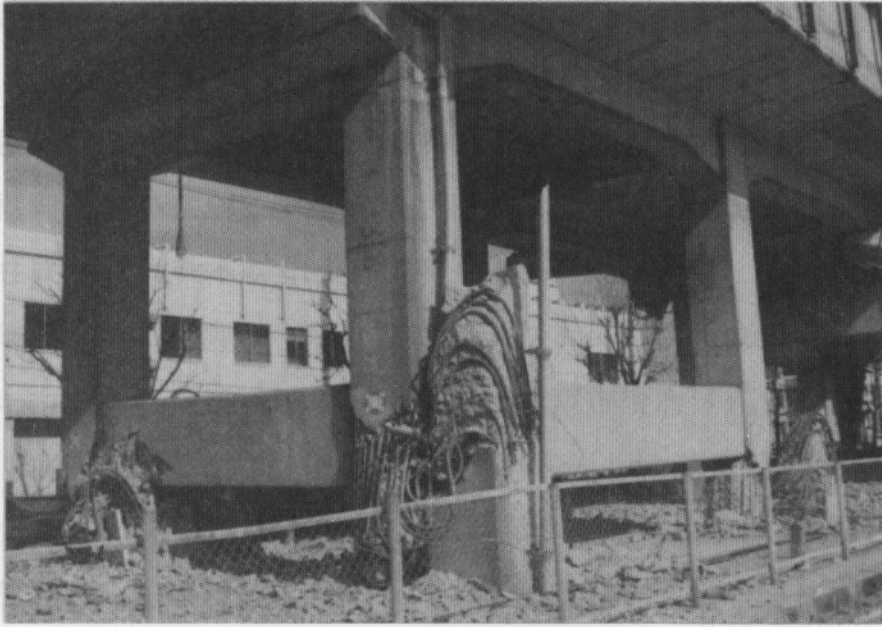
2層ラーメン1層部橋脚の破壊
